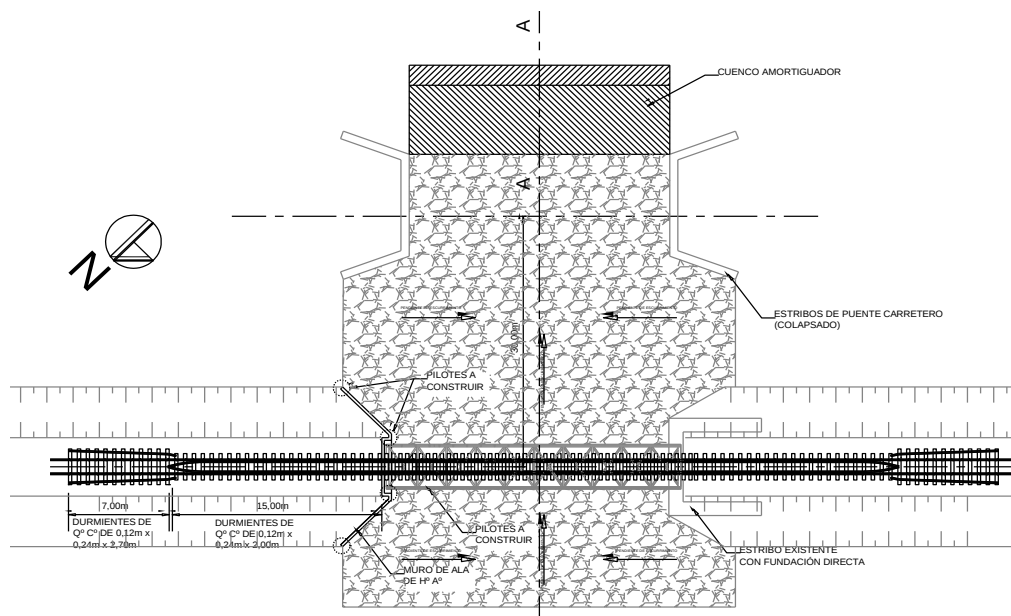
Esquema general de las obras de protección previstas por el Comitente. Planta
